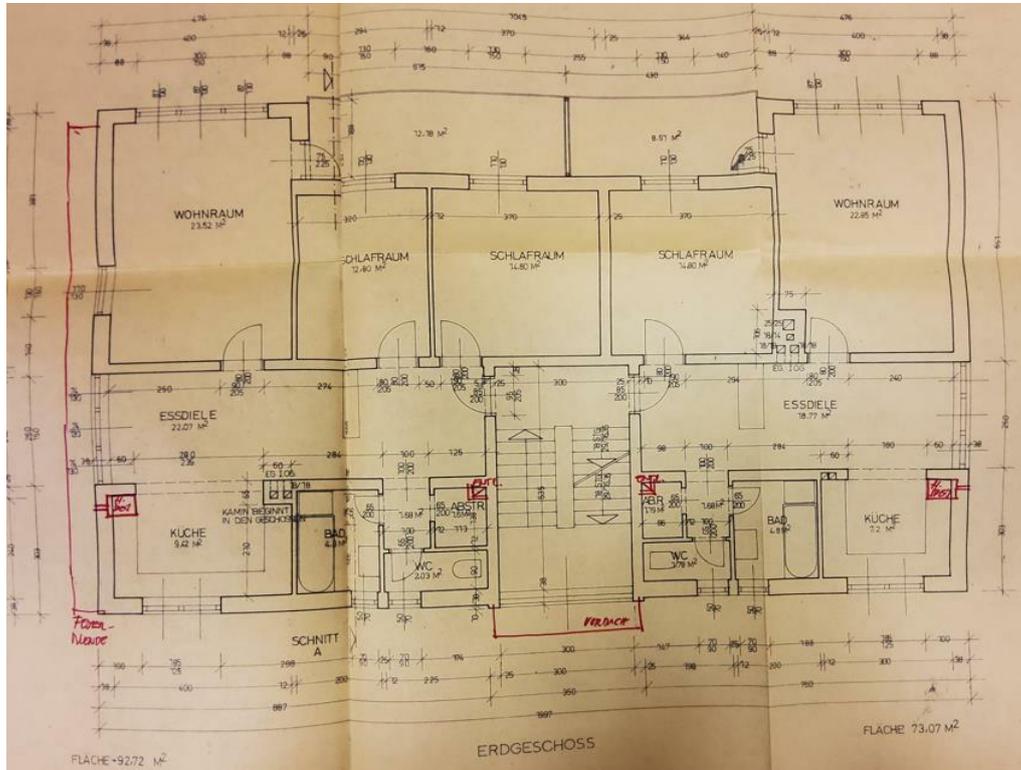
Erdgeschoß; Quelle: Einreichplan Genehmigungsvermerk vom 17.03.1970
